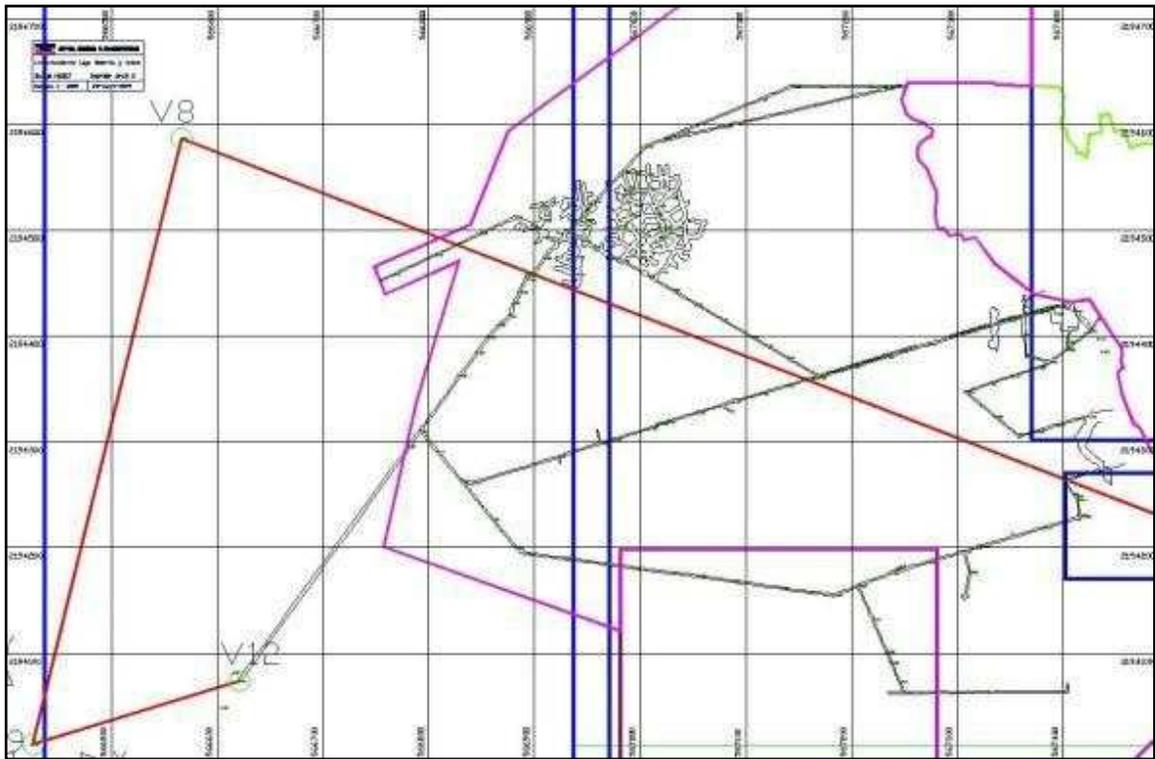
Obras subterráneas levantadas con Topografía (cuadrícula 100m).
